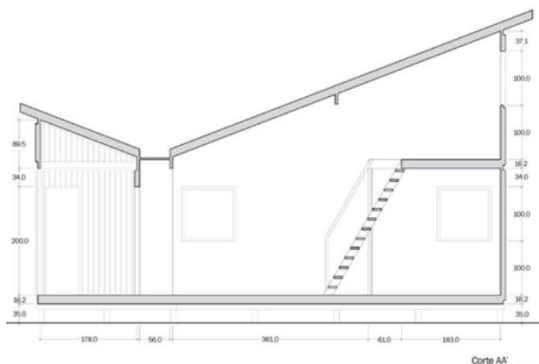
Corte AA'. Fuente: Gubins, J y Baixa, J. (2013).
